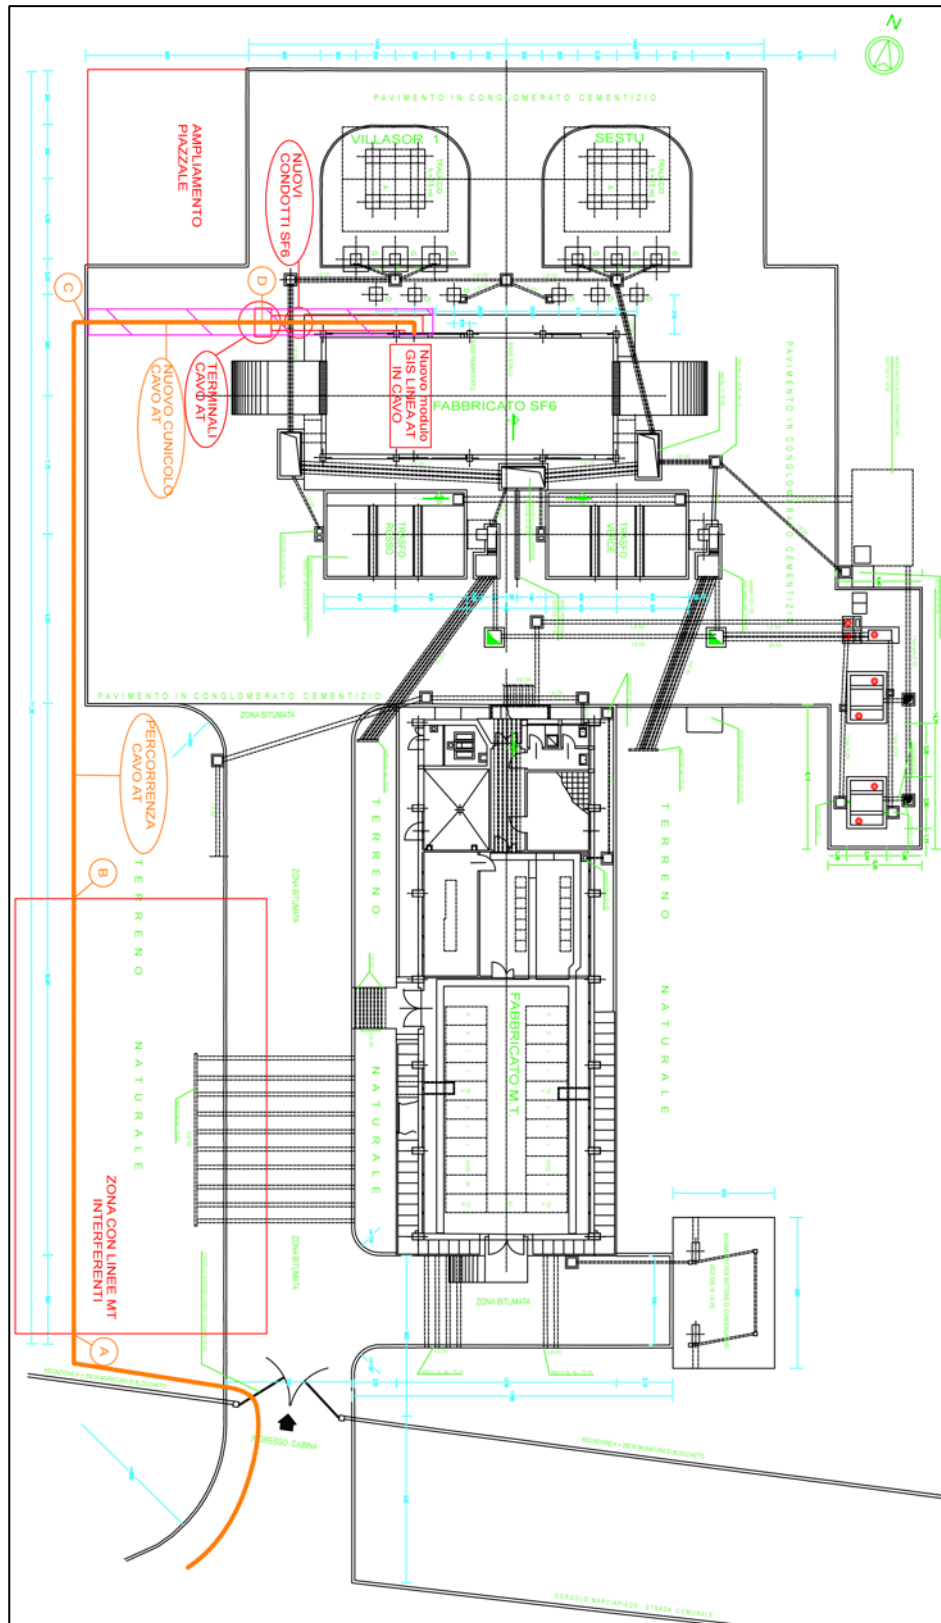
Planimetria della cabina Villazor 2 (nero) ed ampliamenti proposti (rosso e arancio)
